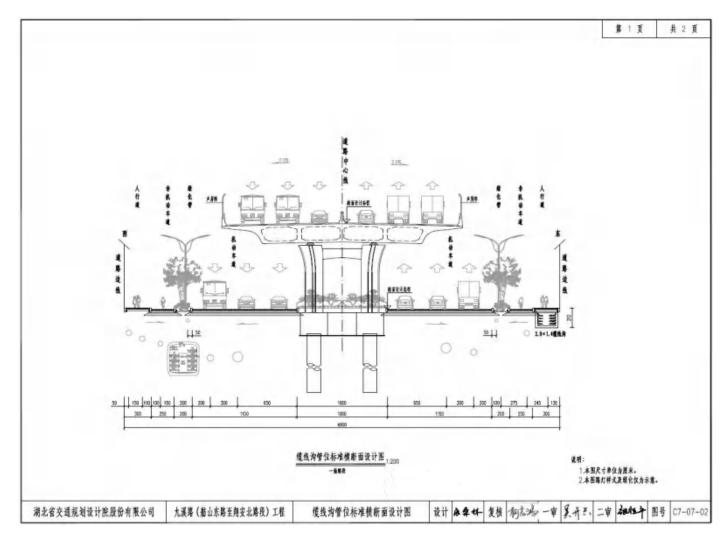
缆线沟管位标准横断面图 (一般路段)
